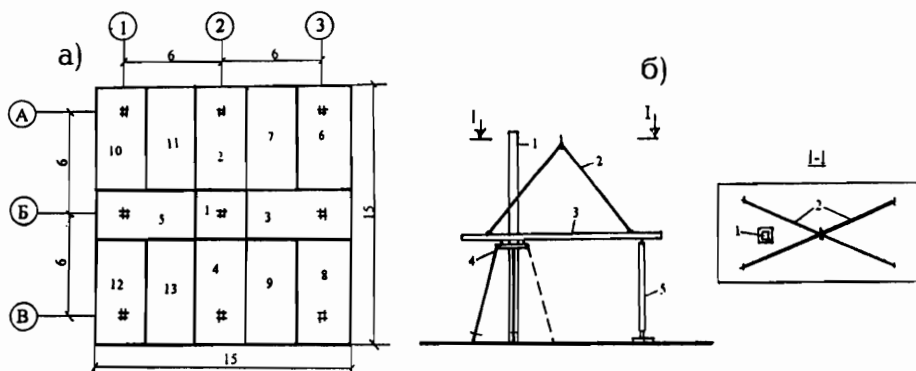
Монтаж укрупненных надколонных и межколонных плит: а – порядок монтажа на захватке; 1...13 – последовательность монтажа плит; б – монтаж плит размером 3х6 м; 1 – колонна; 2 – четырех-ветвевой строп; 3 – надколонная плита; 4 – приспособление для раскрепления колонны; 5 – временная монтажная опора
